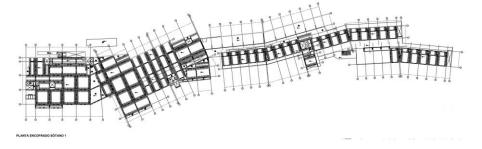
Plano de encofrado sótano 1. Fuente: Elaboración propia.
